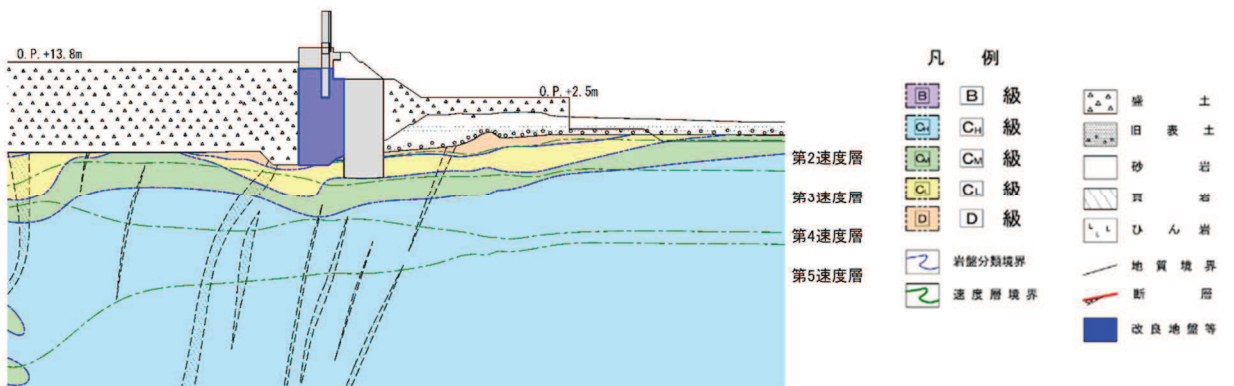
地盤改良体の配置図 (防潮堤 (鋼管式鉛直壁) 一般部, F-F 断面)
